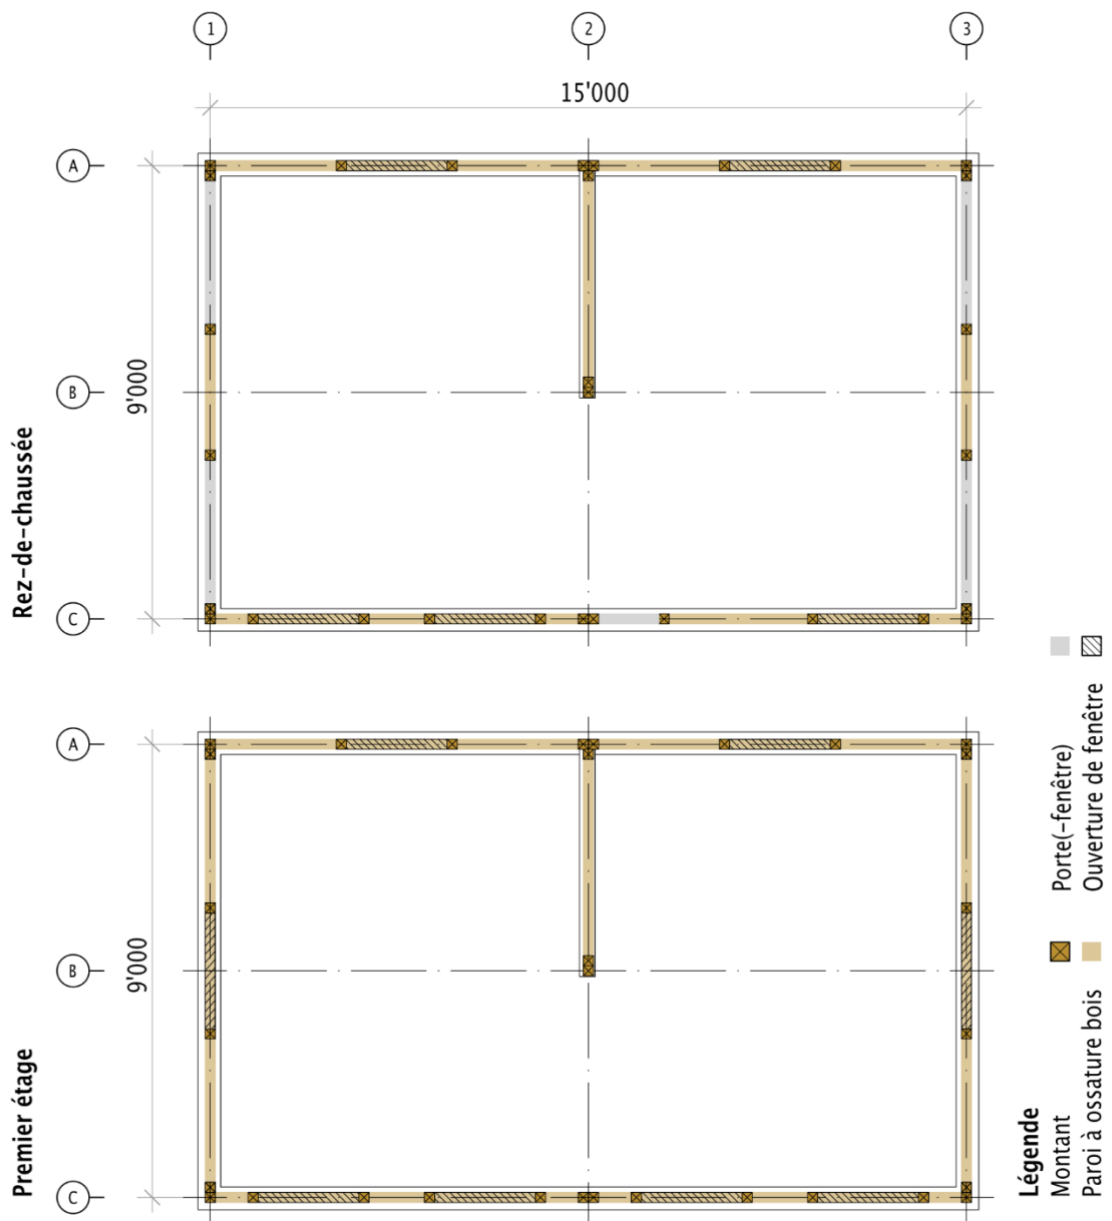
Plan schématique du rez-de-chaussée et du premier étage du bâtiment modèle à deux étages.
